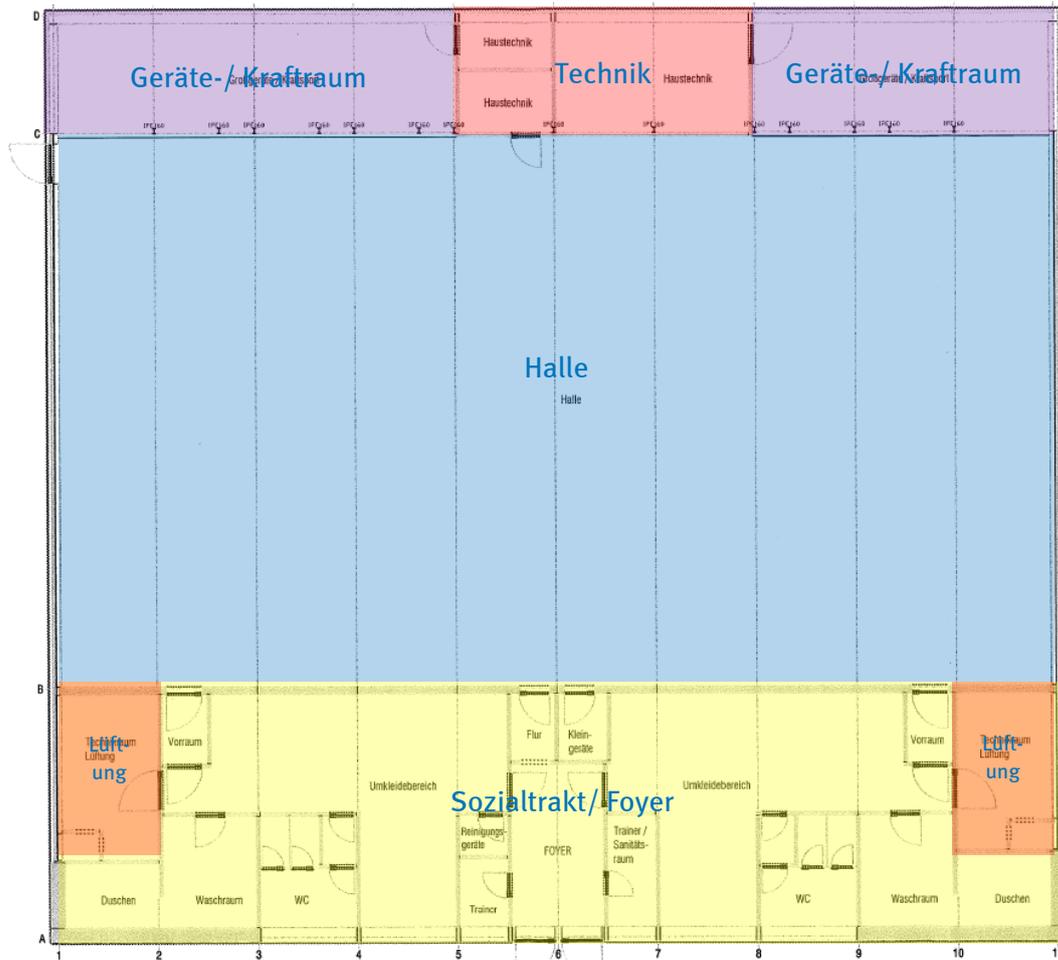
Grundriss TH 3 - Typ KT 60L (Quelle: ZGM)
